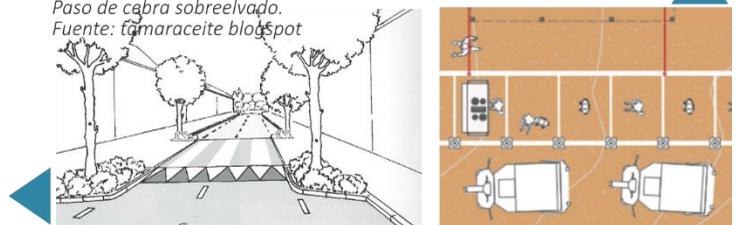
Paso de cebra sobre elevado. Fuente: Camaraceite Blogspot. (s/f)
